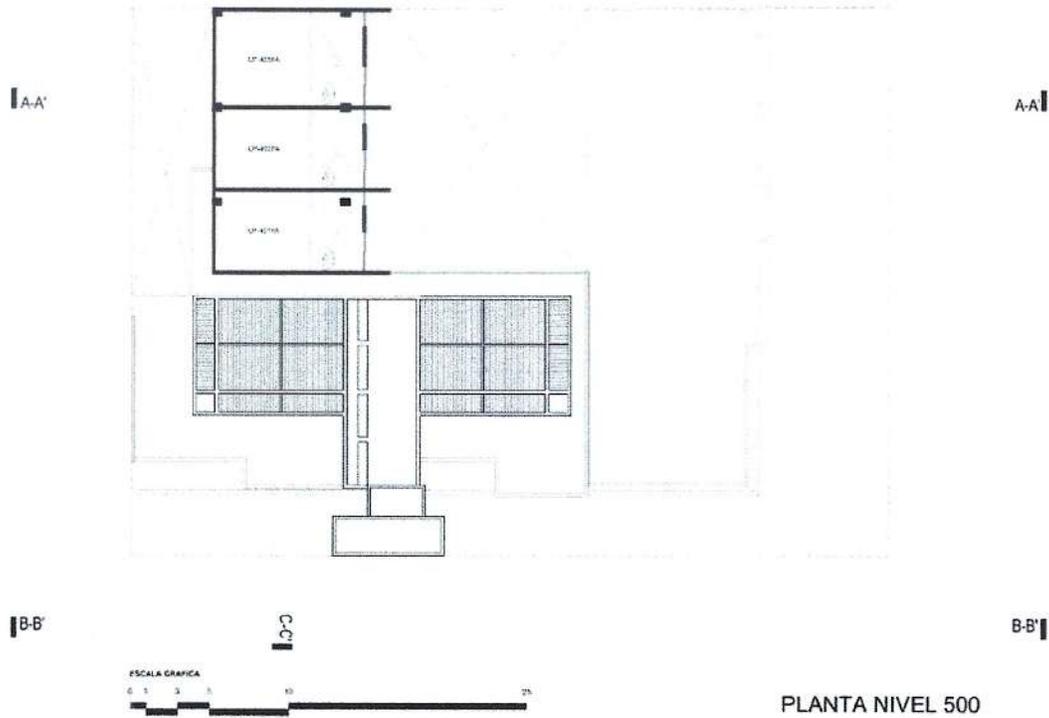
Anteproyecto de la planta tres y cuatro. Departamentos y rooftop.
